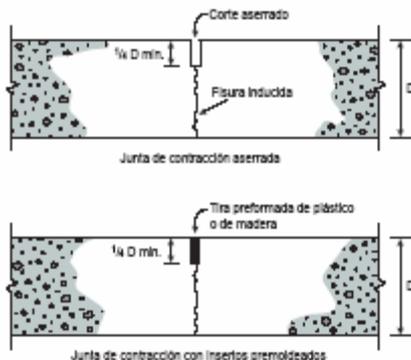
Juntas de contracción proveen el movimiento horizontal en el plano de la losa o del muro e induce fisuras controladas que se causan por la contracción por secado y térmica.
